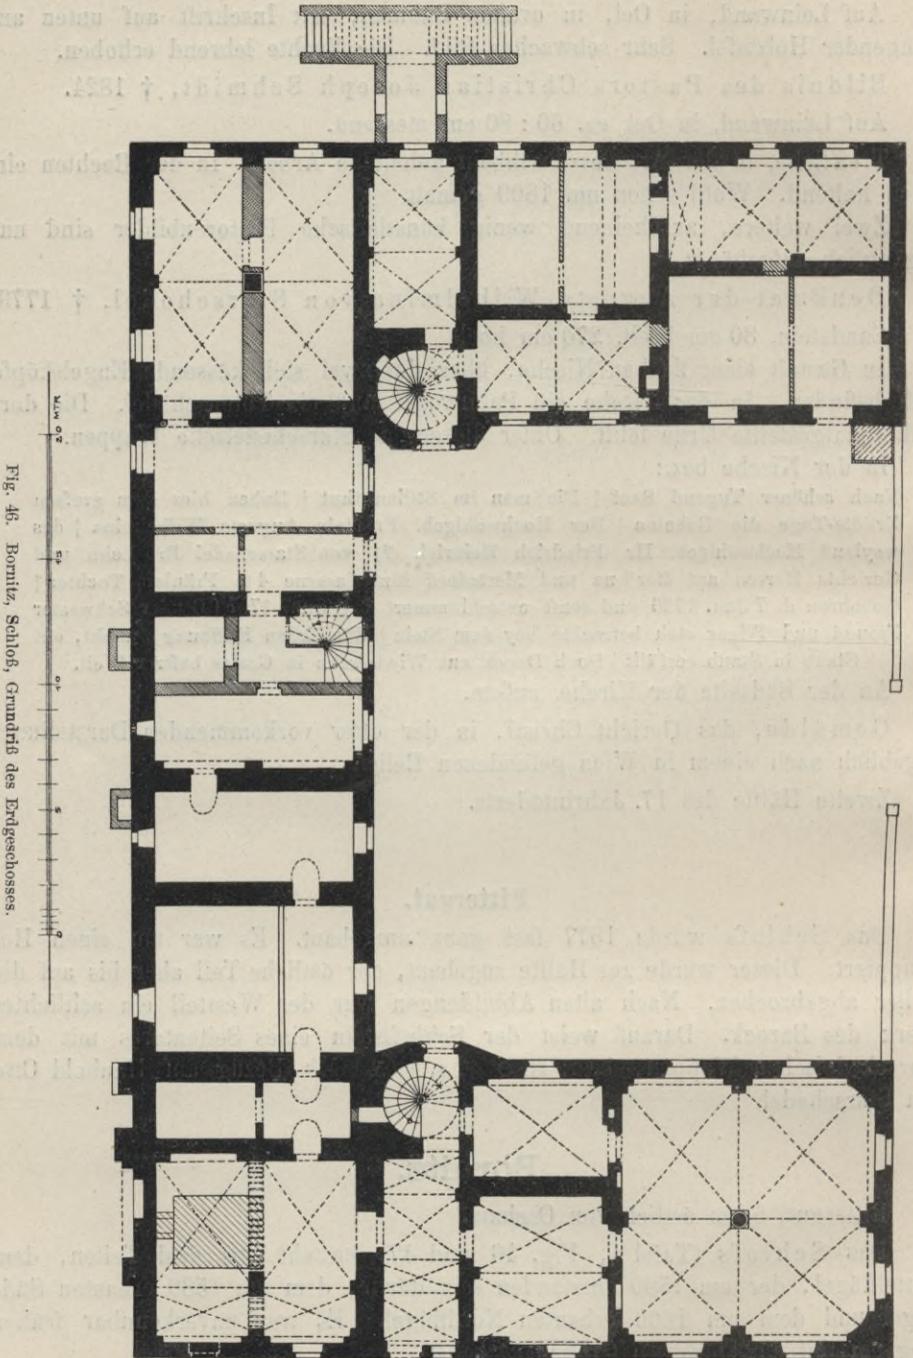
Bornitz, Schloss, Grundriß des Erdgeschosses.
